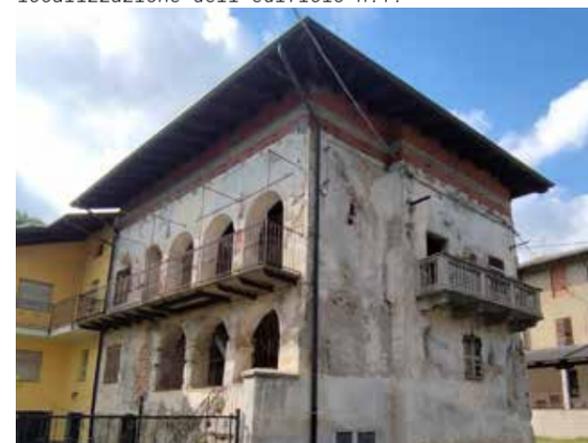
Dettaglio prospetto Sud, edificio n.1, Brosso, Valchiusella (TO)
